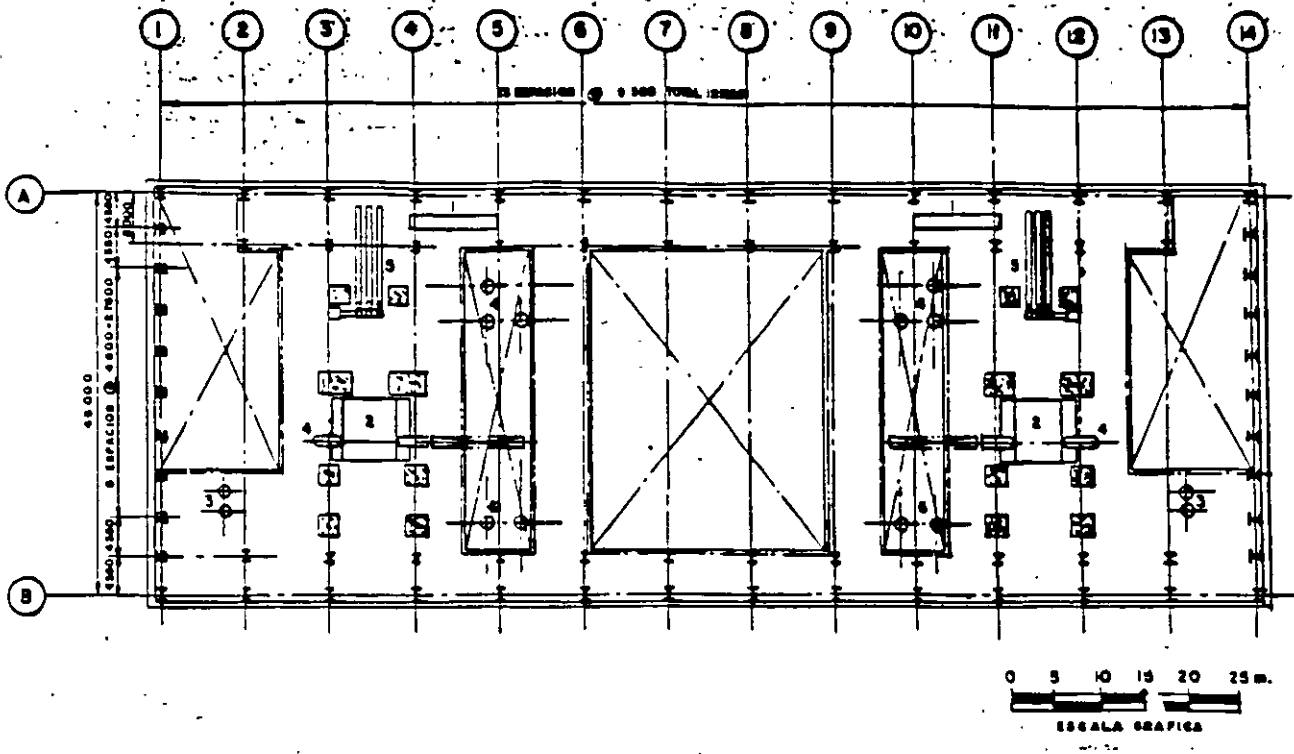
Casa de Máquinas: Arreglo de Equipo Mezzanine Planta Niv. 6.000 m.
